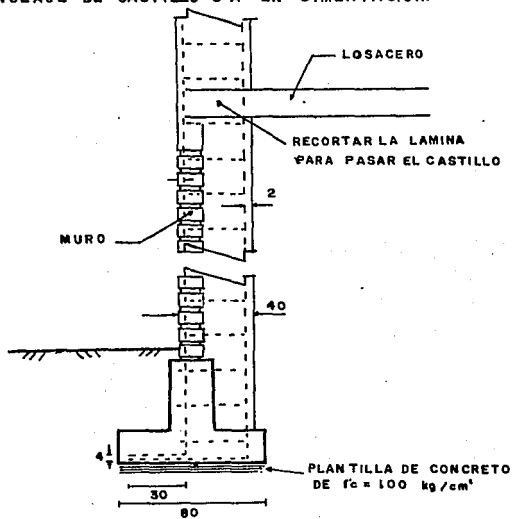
ARREGLO ESTRUCTURAL DE MUROS FACHADA LATERAL
